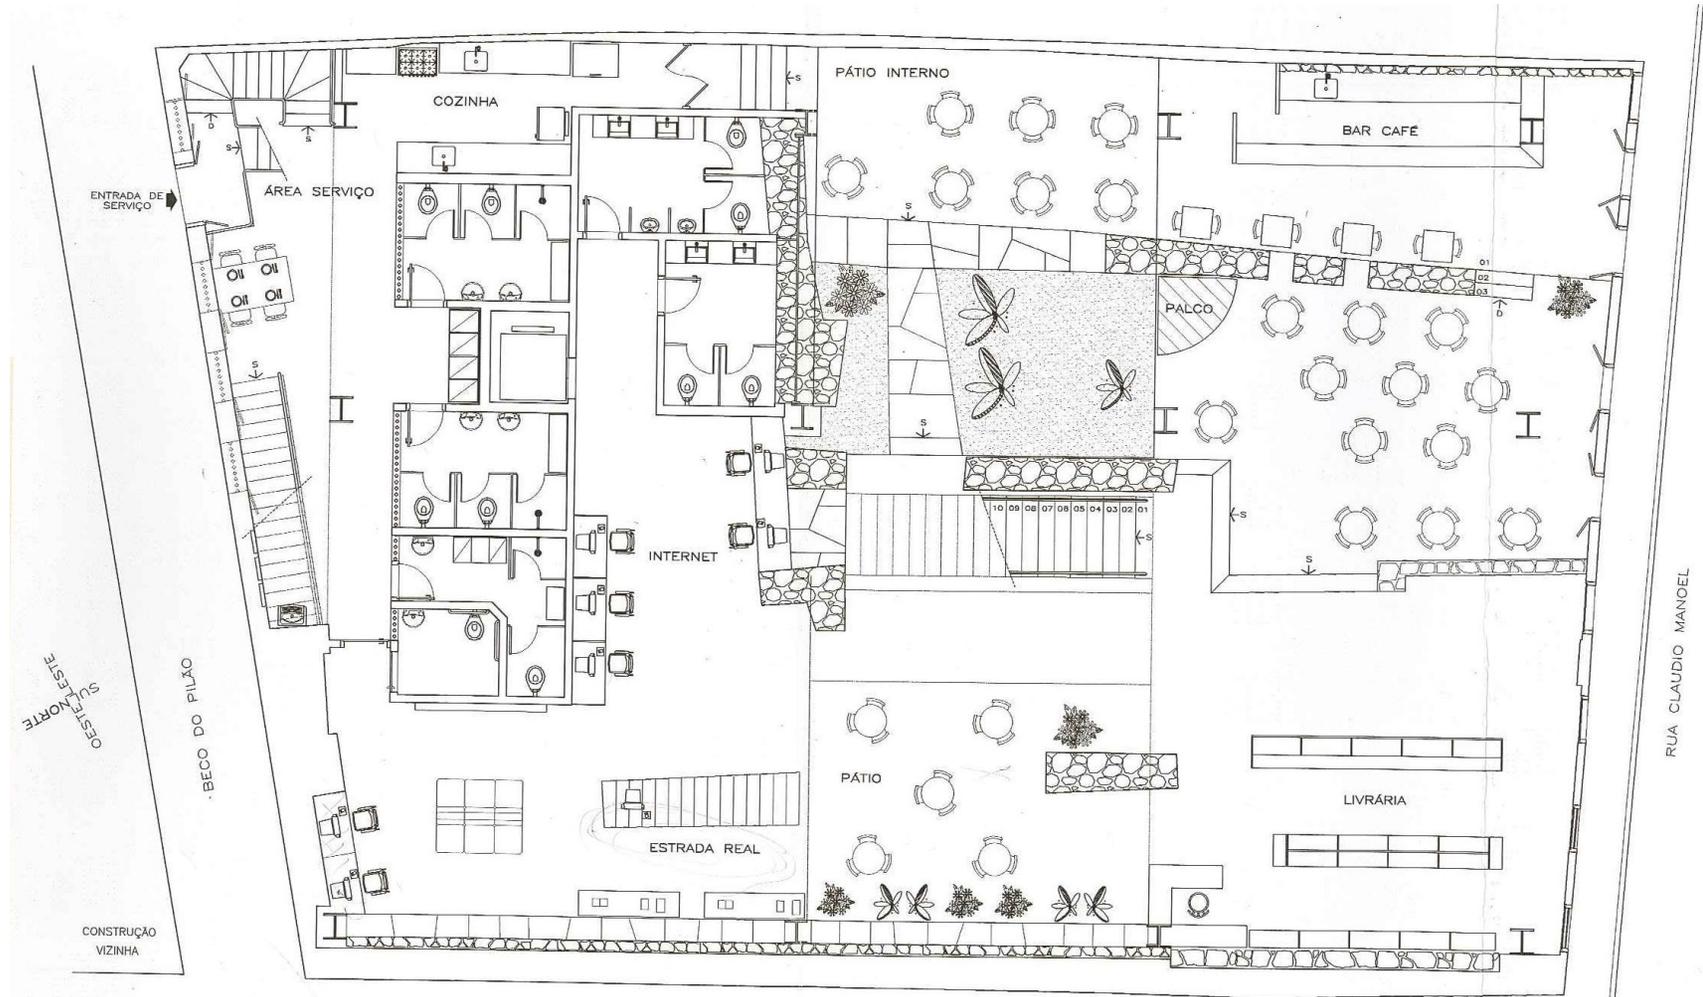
Planta do Subsolo. Fonte: SESI/FIEMG, 2014.
